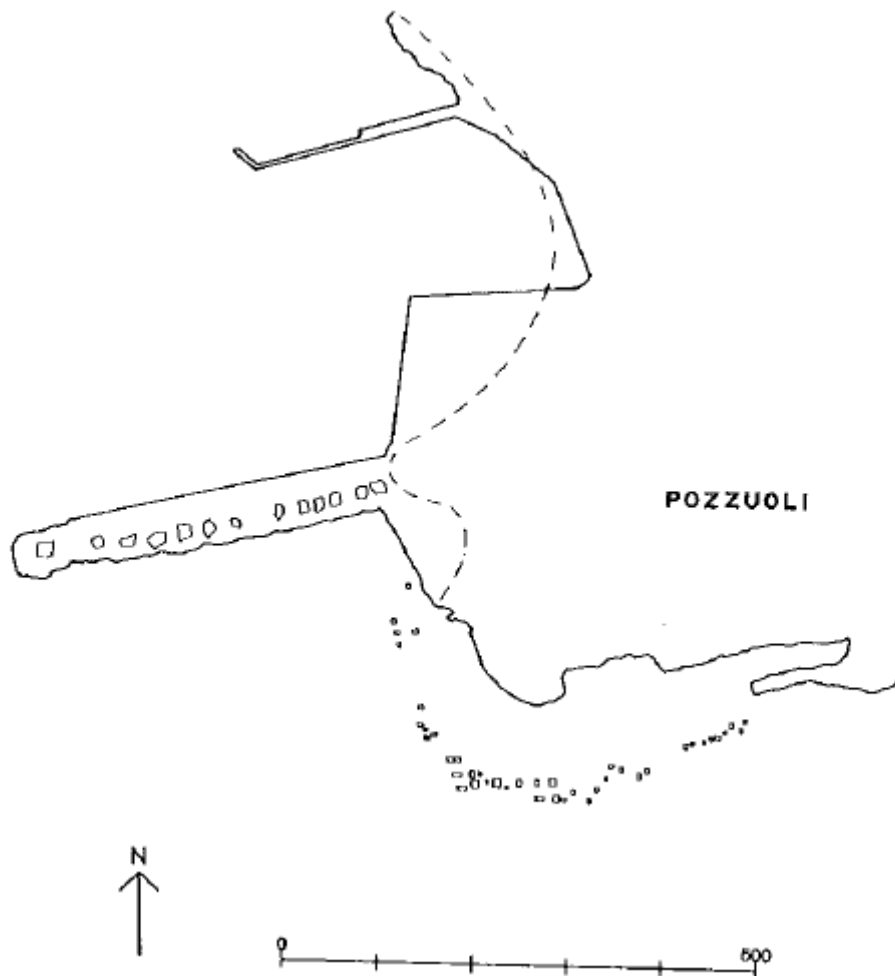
Planimetría del muelle de Puteoli sepultado por el puerto moderno y conjunto de pilares al sur del Rione Terra. (GIANFROTTA, P. A. 1996, p. 68).
